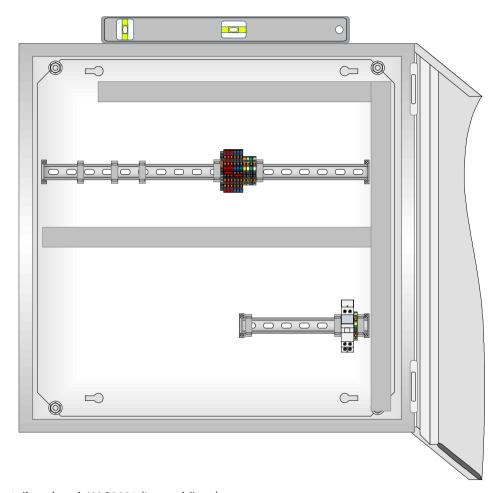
Verteilerschrank HAC0001 (Leergehäuse)
